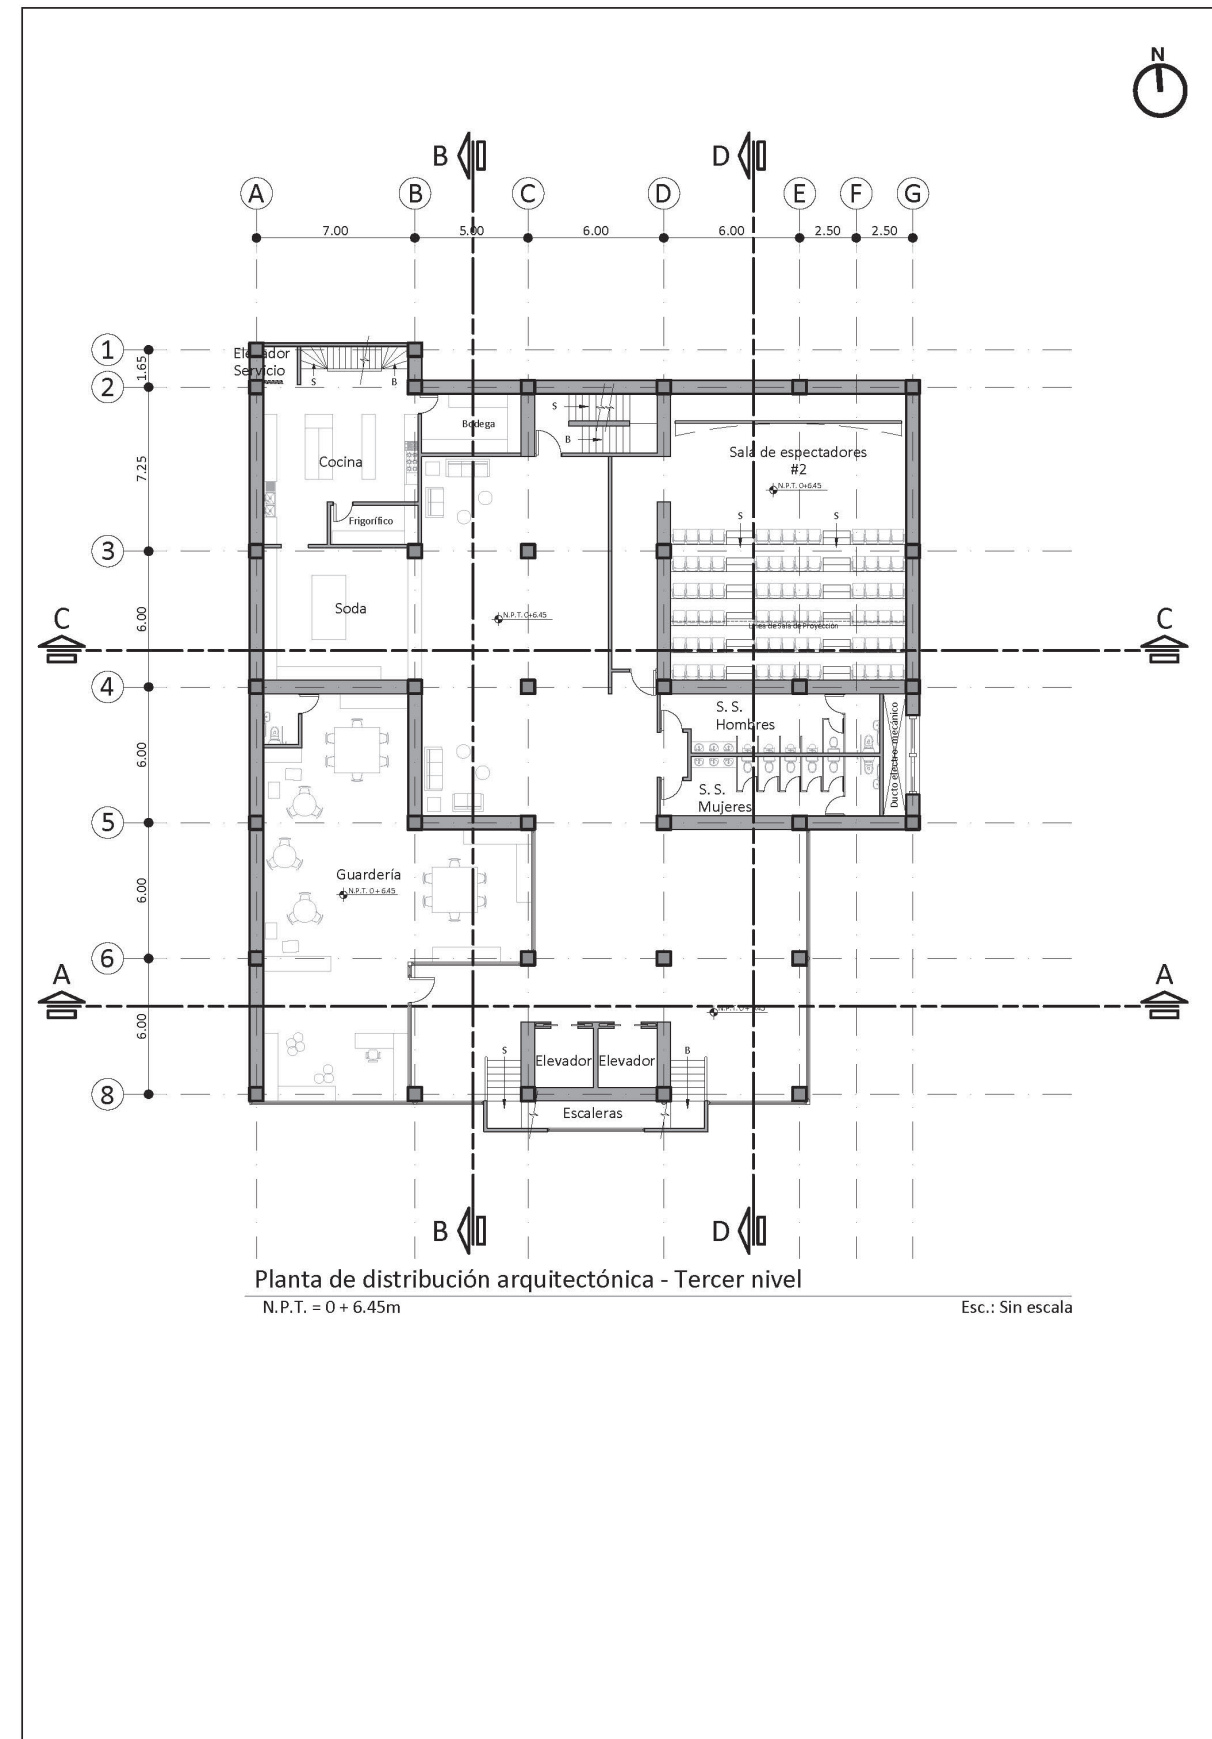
Planta de distribución arquitectónica de tercer nivel. Fuente: Propia.
